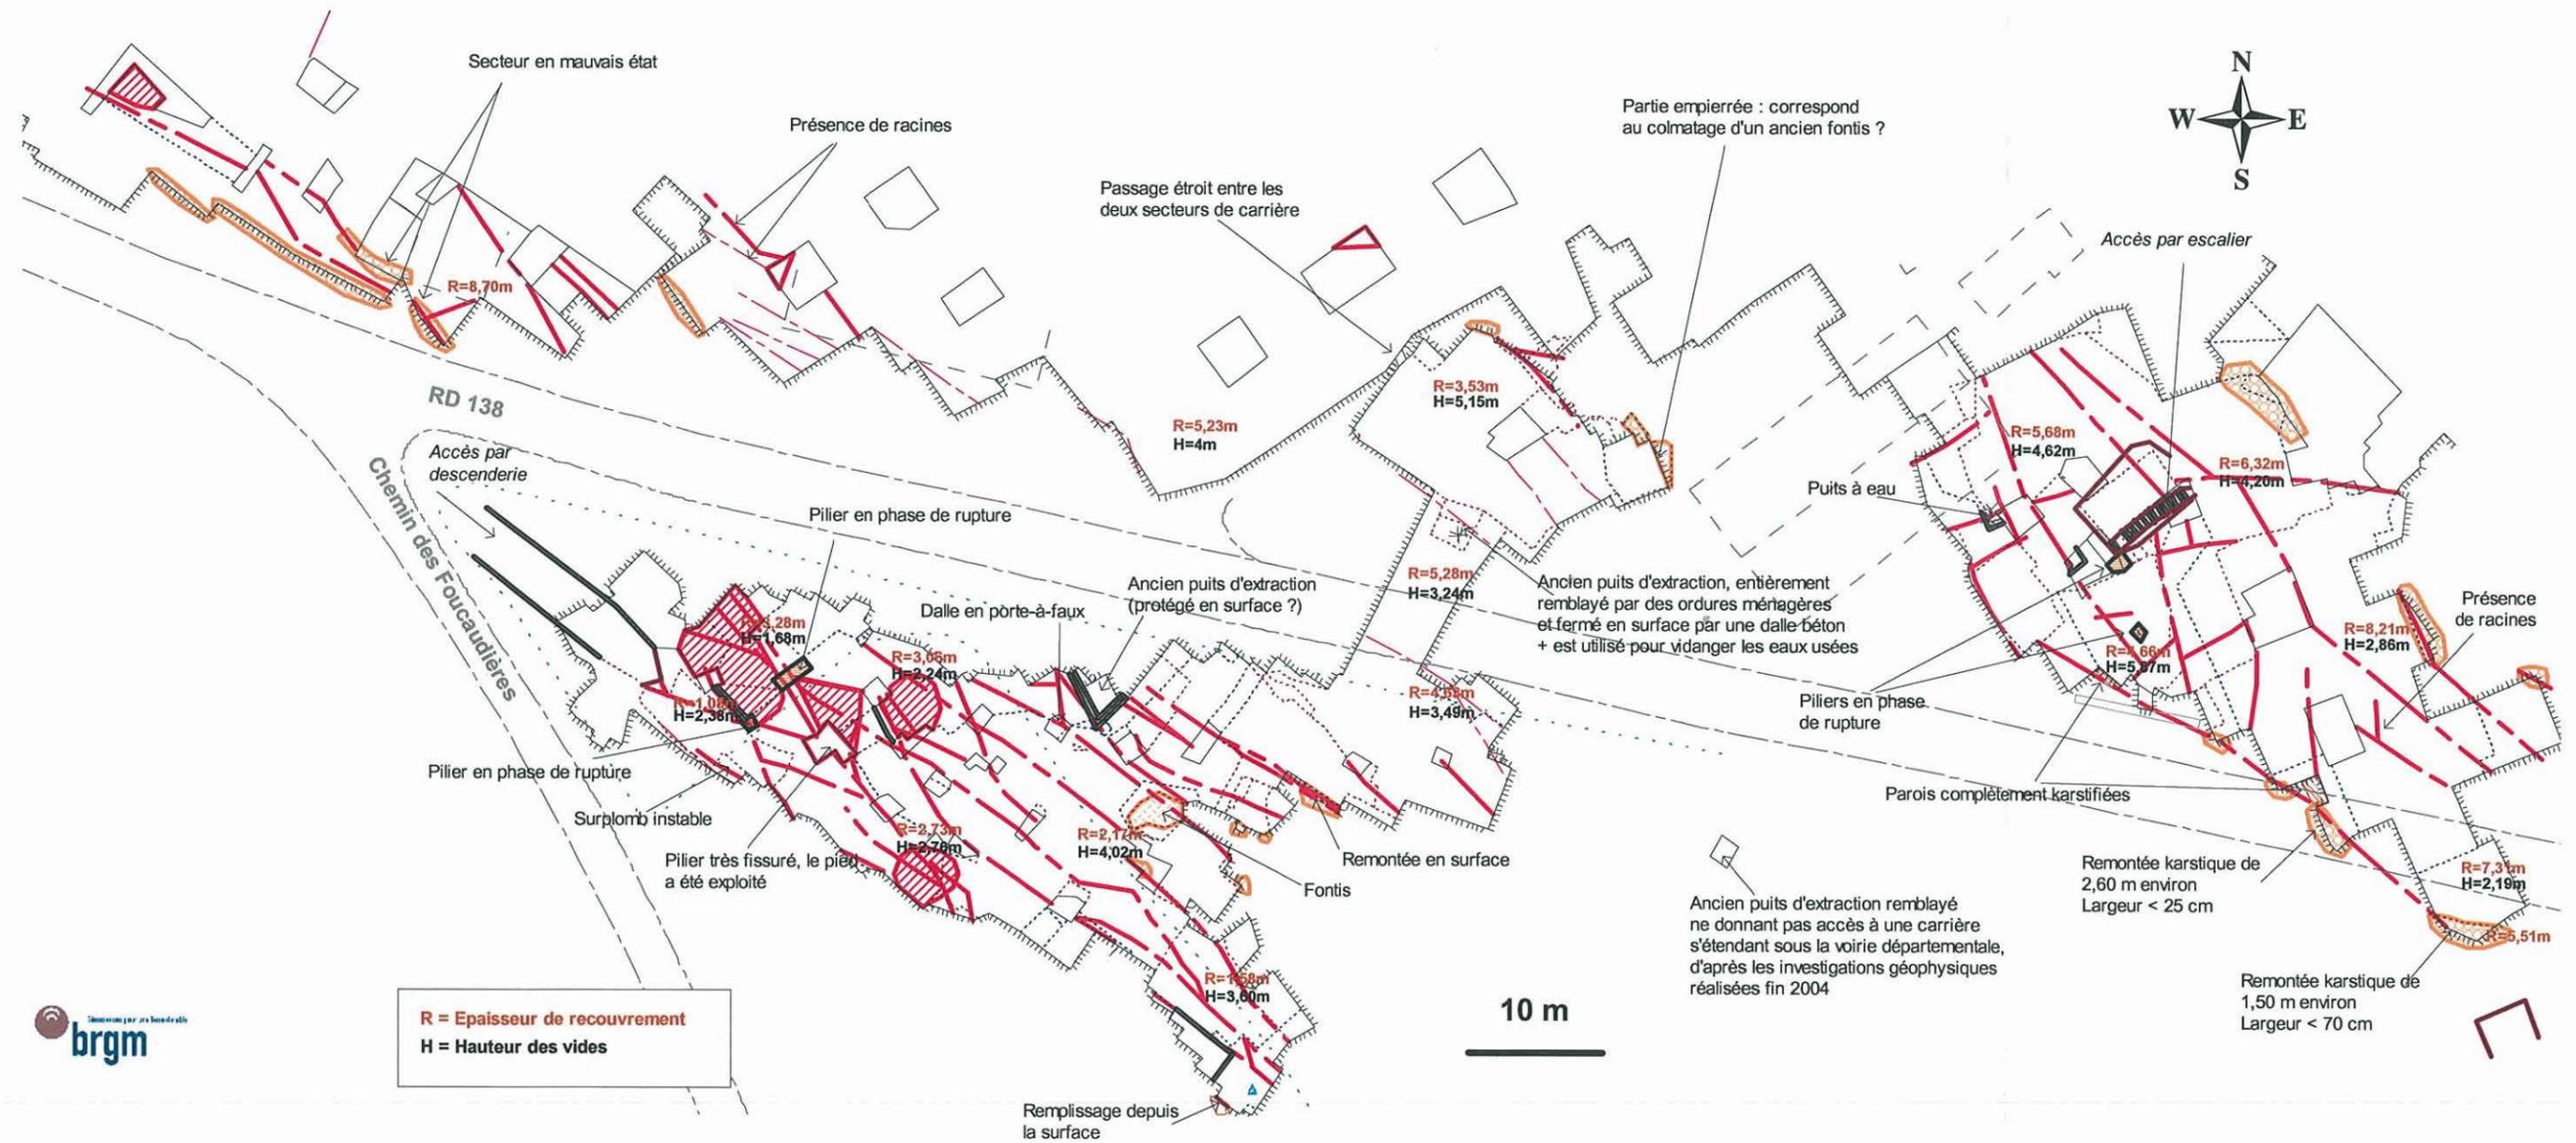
Carrière "Les Mauds" à Thénac – Relevés géotechniques sur fond de plan levé par un géomètre-expert
